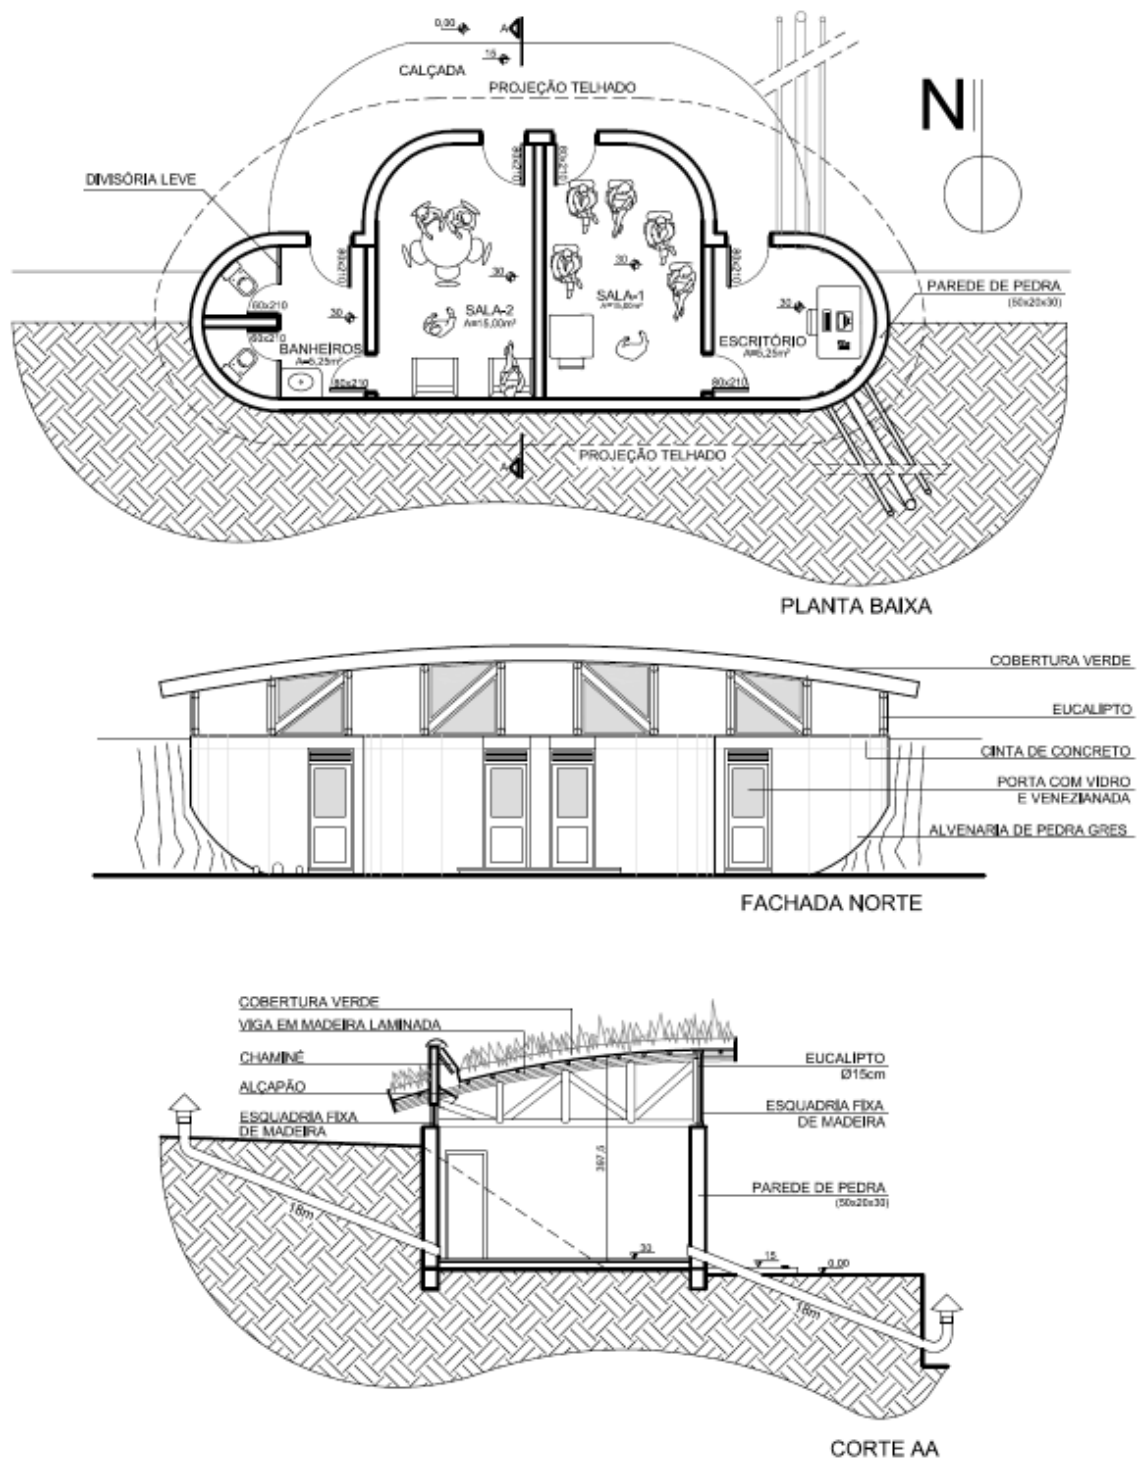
planta baixa, fachada norte e corte AA do Protótipo Ventura
